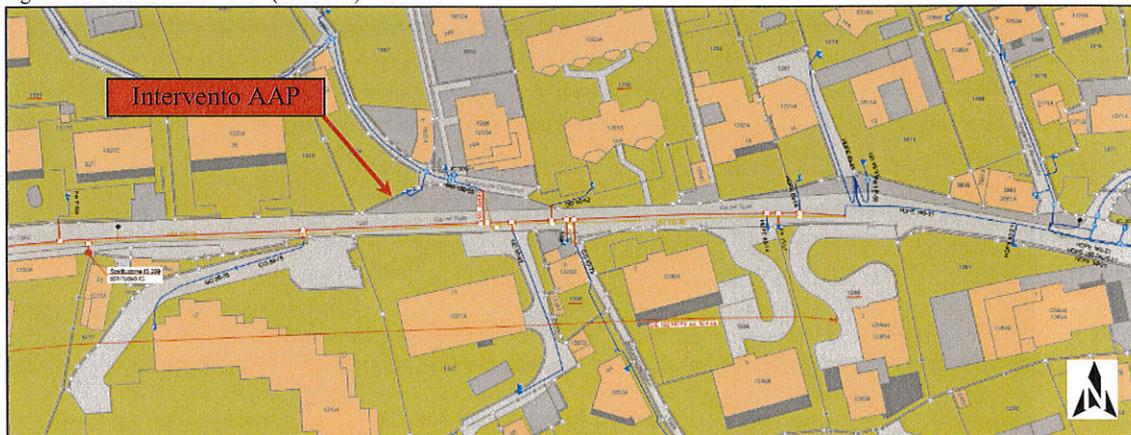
Planimetria d'intervento (tratta centrale) – lotto 5.
